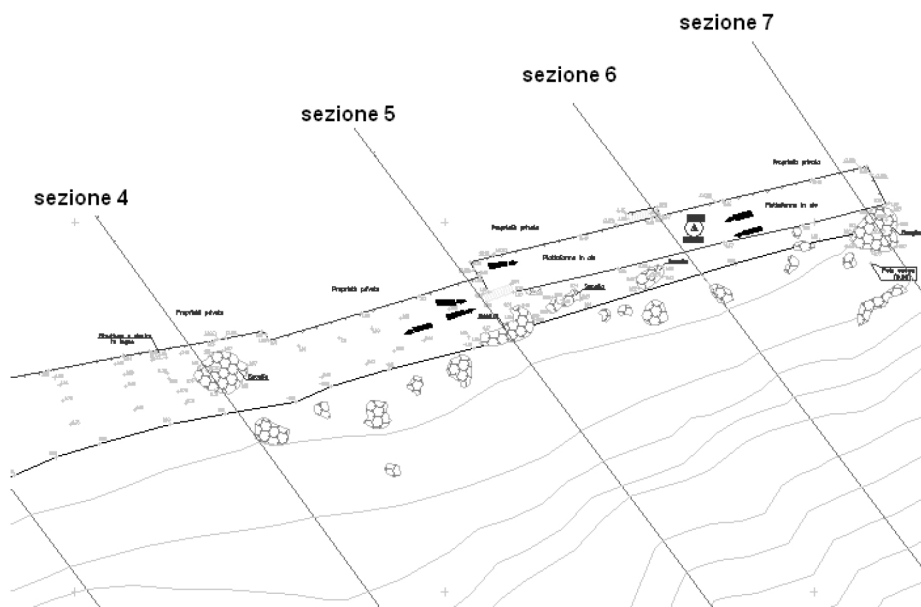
Planimetria della Spiaggia dei Tedeschi (Ovest)
